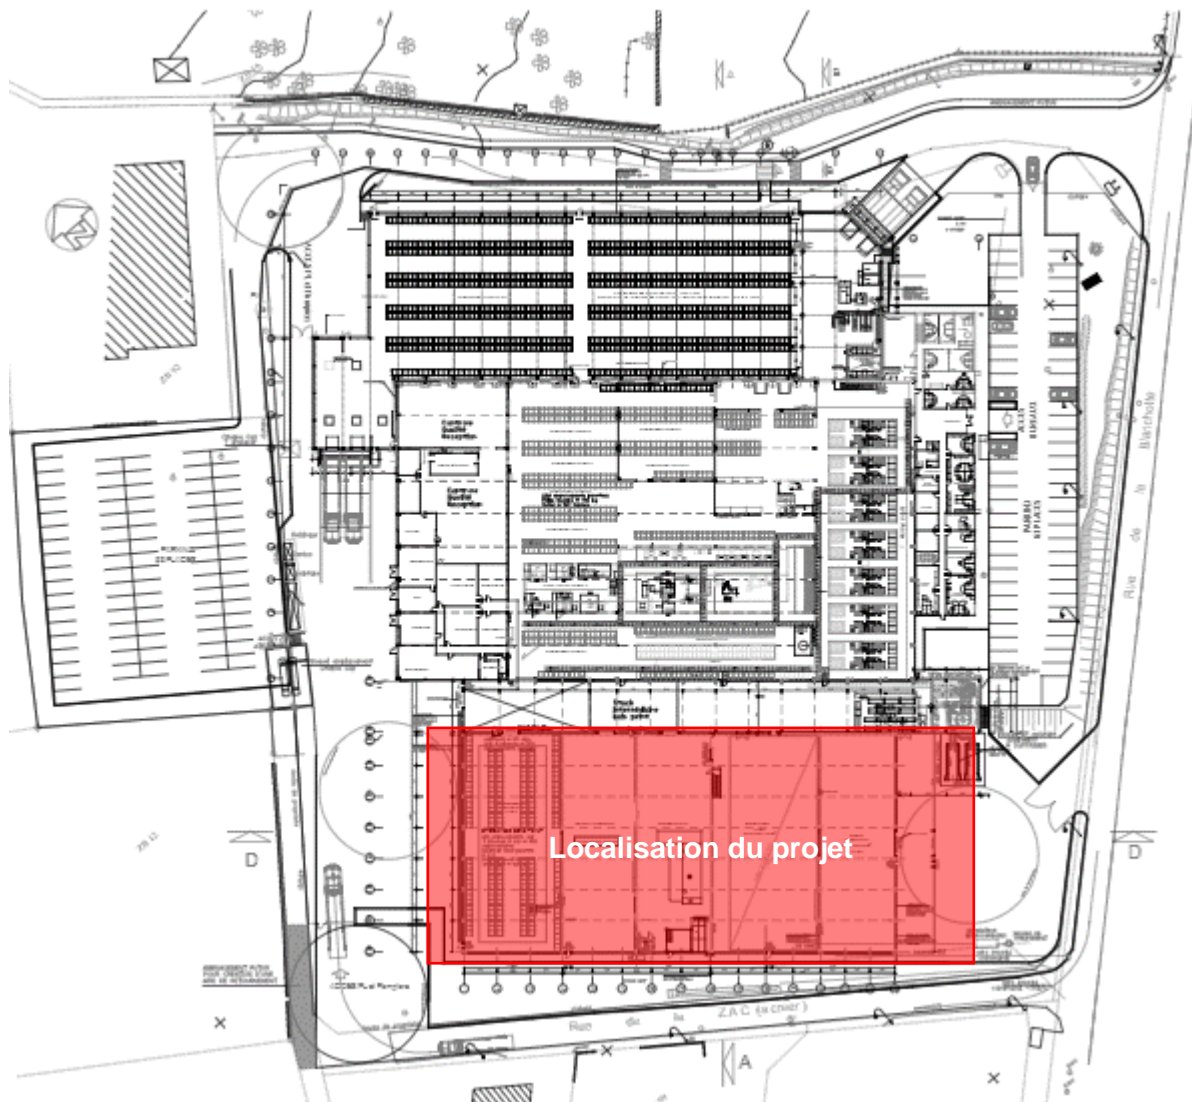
PLAN DU SITE IDENTIFIANT LE PROJET
